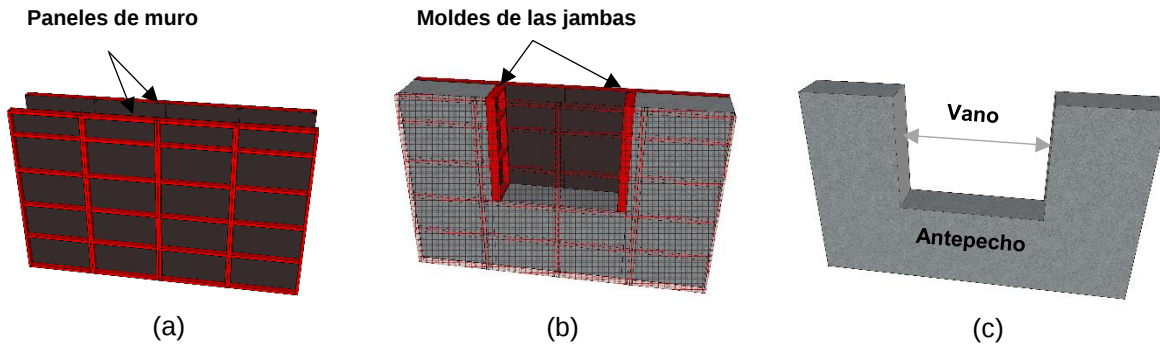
Proceso constructivo de vanos originados como abertura de un muro: (a) paneles de muro; (b) molde de las jambas al interior del panel de muros; (c) vano y antepecho
